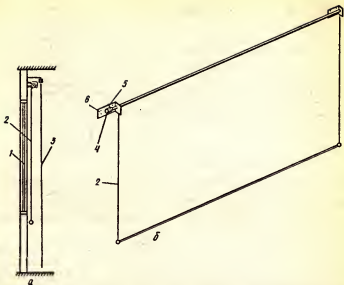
Схема крепления (а) и конструкция (б) солнцезащитной шторы:
